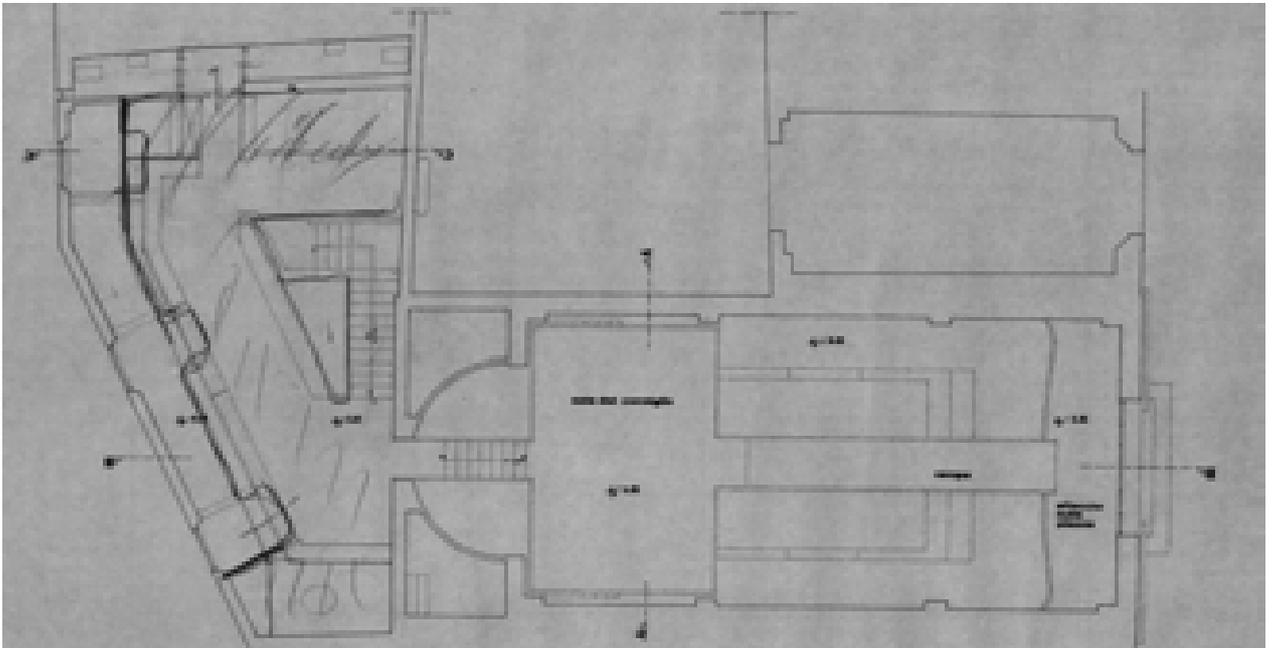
Studio pianta - s.d. (AABS-94.092)
